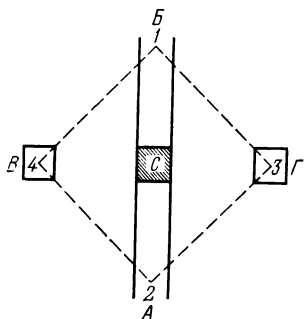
Схема расположения четырех опор надстройки под крышей здания
